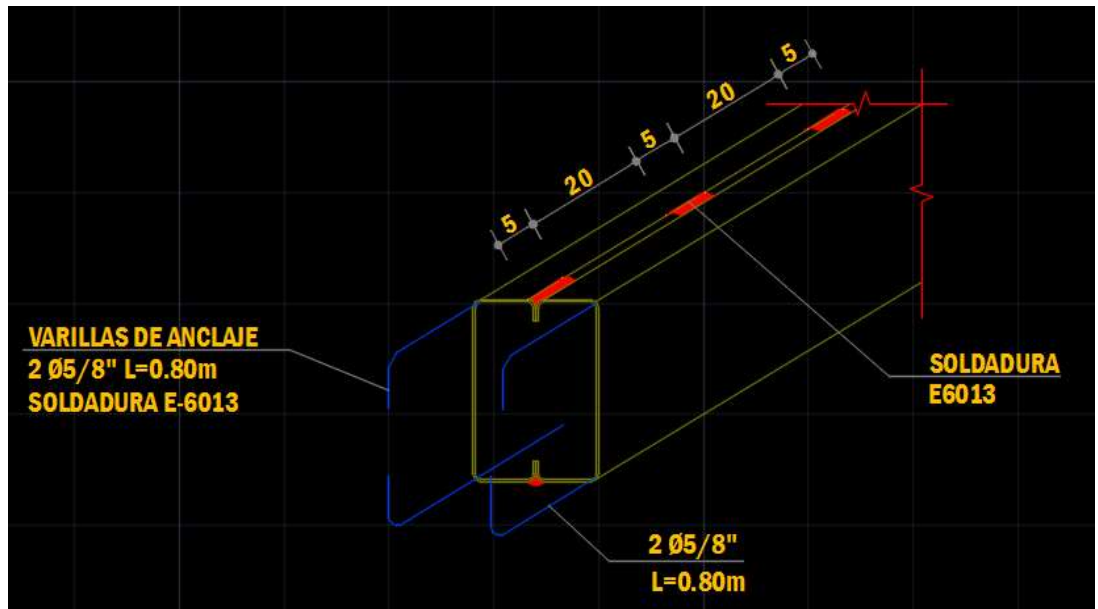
Sistema de anclaje a viga. Especificación puntos de soldadura.
